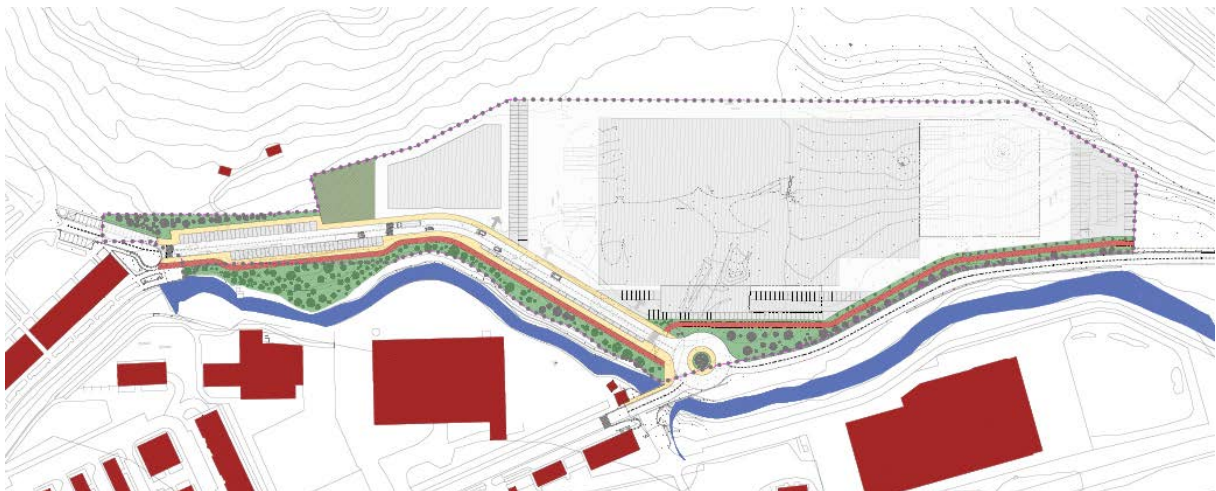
Ordenación pormenorizada propuesta en el sector S-1b. Fuente: Plano 04 'Ordenación' del Plan Parcial.
